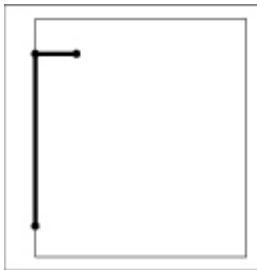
La tabiquería vista en planta con el trazado de las líneas de corte.
